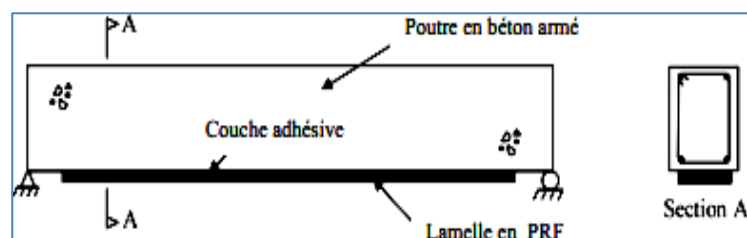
Renforcement par une lamelle en PRF d'une poutre.
